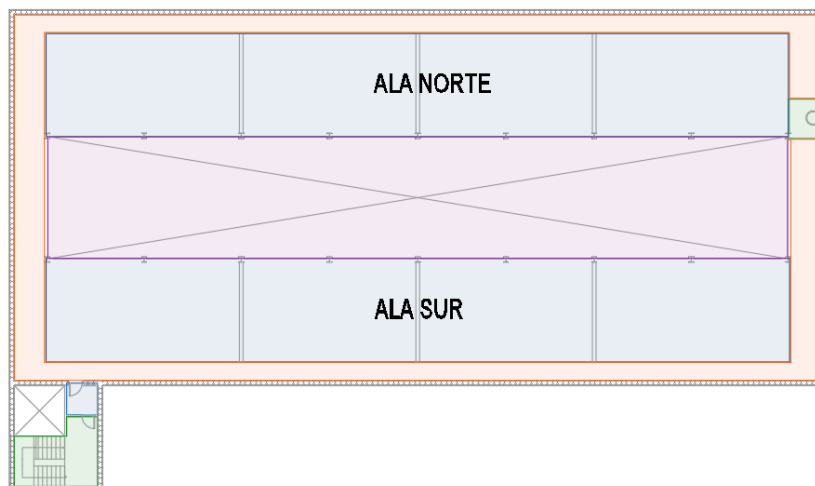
Distribución Niveles -1, -2 y -3. Fuente propia.
